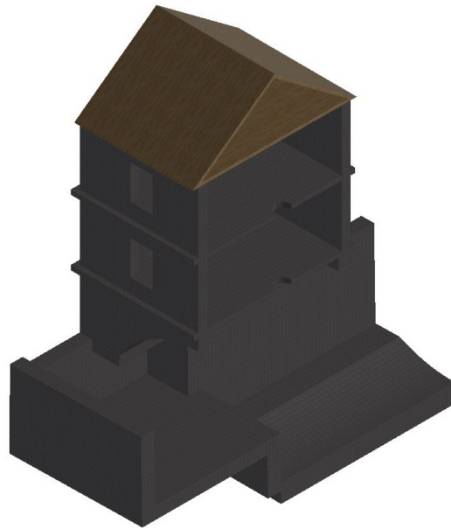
Vista de la fábrica de ladrillo soporte del mecanismo.
